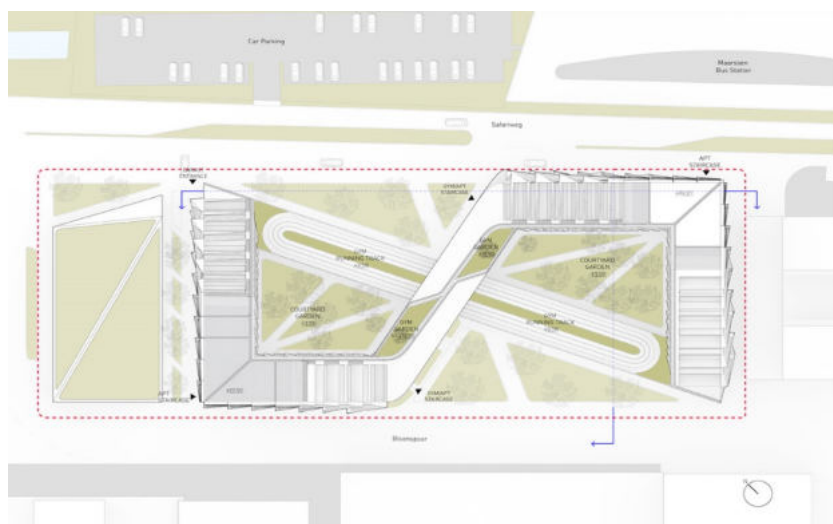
Plano de techo. Fuente: <https://www.archdaily.com>. Año 2017.
